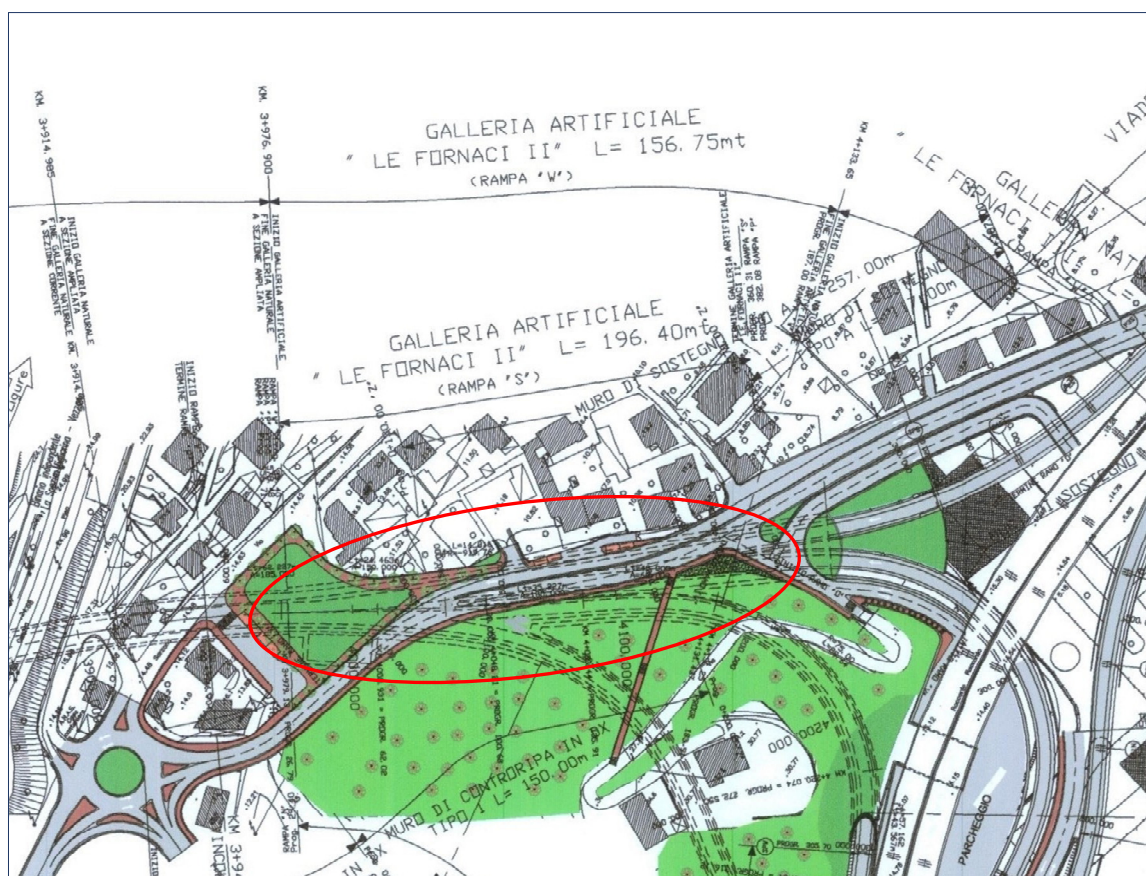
Galleria artificiale Fornaci II – Ubicazione planimetrica
